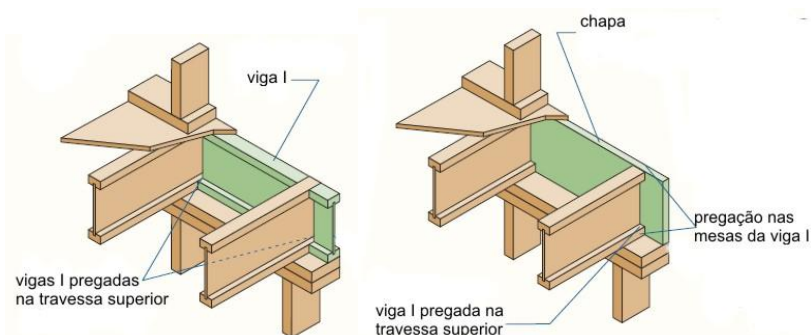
Travamento lateral e das extremidades das vigas de perfil I no entrepiso. Fonte: adaptação APA, 2009.
